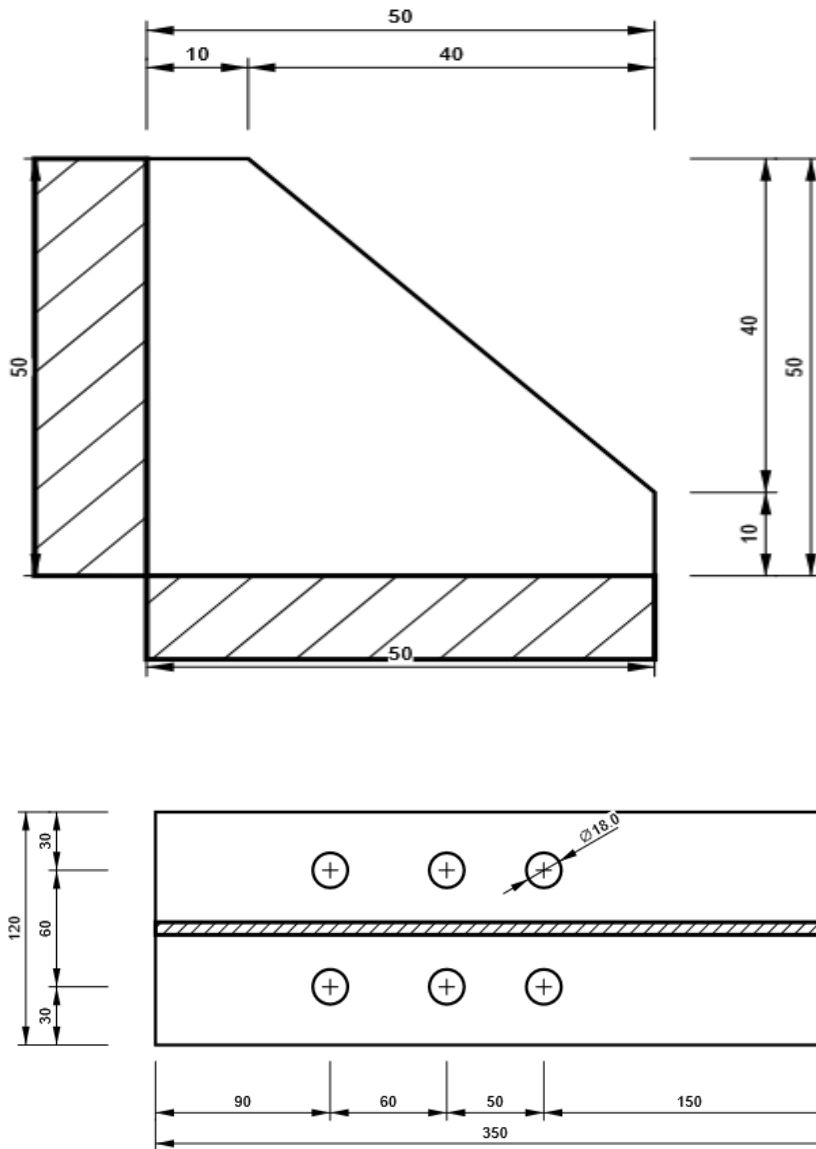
Conexiones entre vigas y pilares en 2D. Fuente: Resultante del cálculo.
